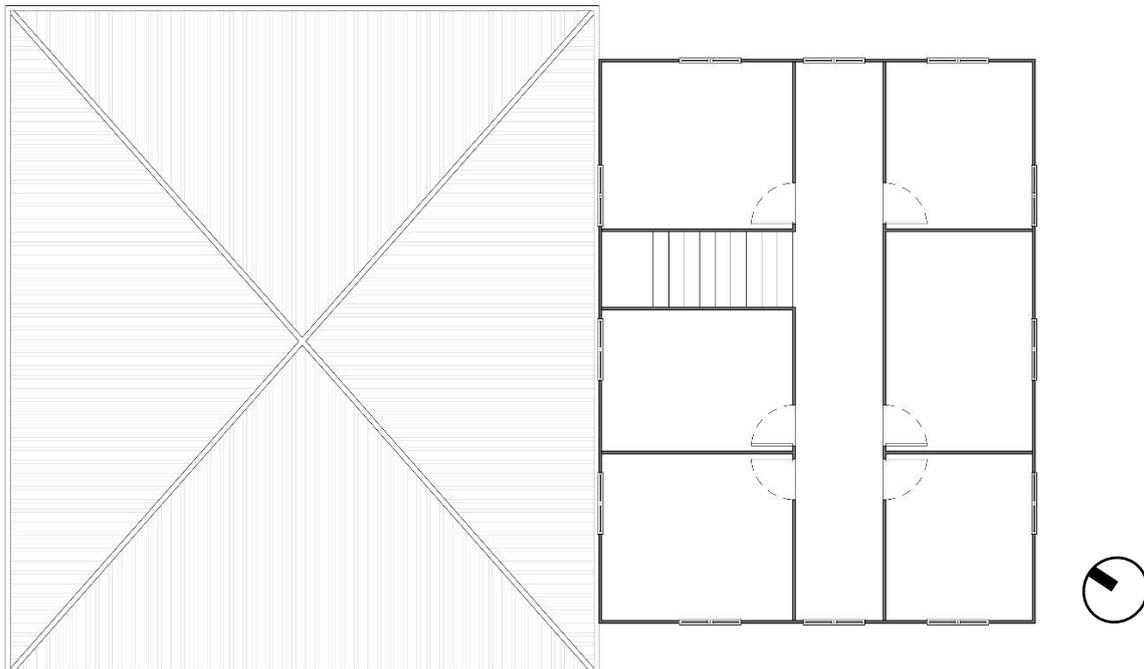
Planta baixa pavimento térreo – S/Escala.
